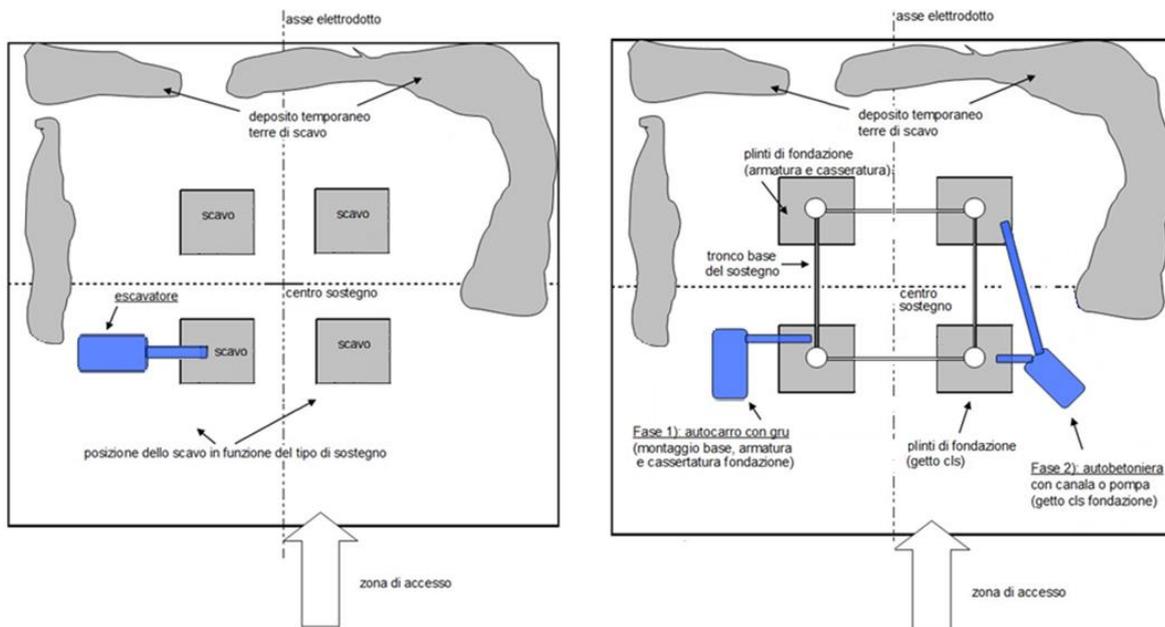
Planimetria dell'Area Sostengo (Scavo di fondazione – getto base).
